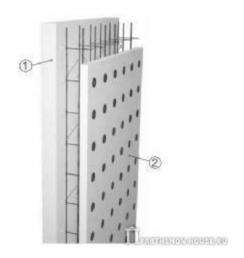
Несъемная опалубка для несущих стен: 1. Наружная пенополистирольная плита; 2. Внутренняя пенополистирольная плита.
